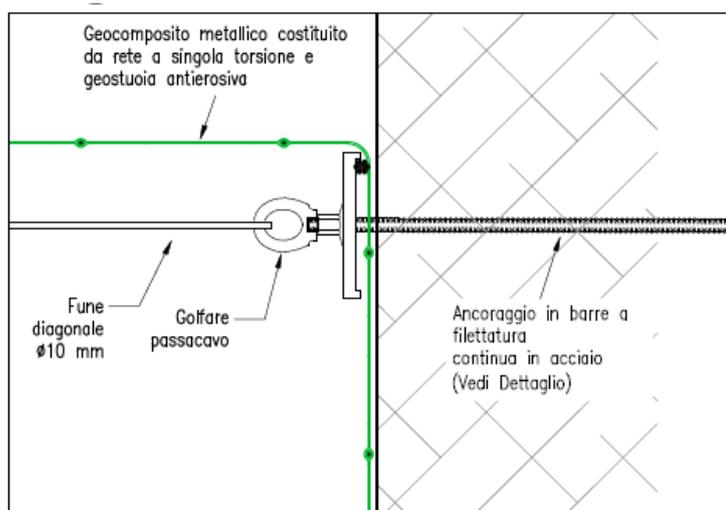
Particolare Piastra di bloccaggio in testa alla barre di ancoraggio
